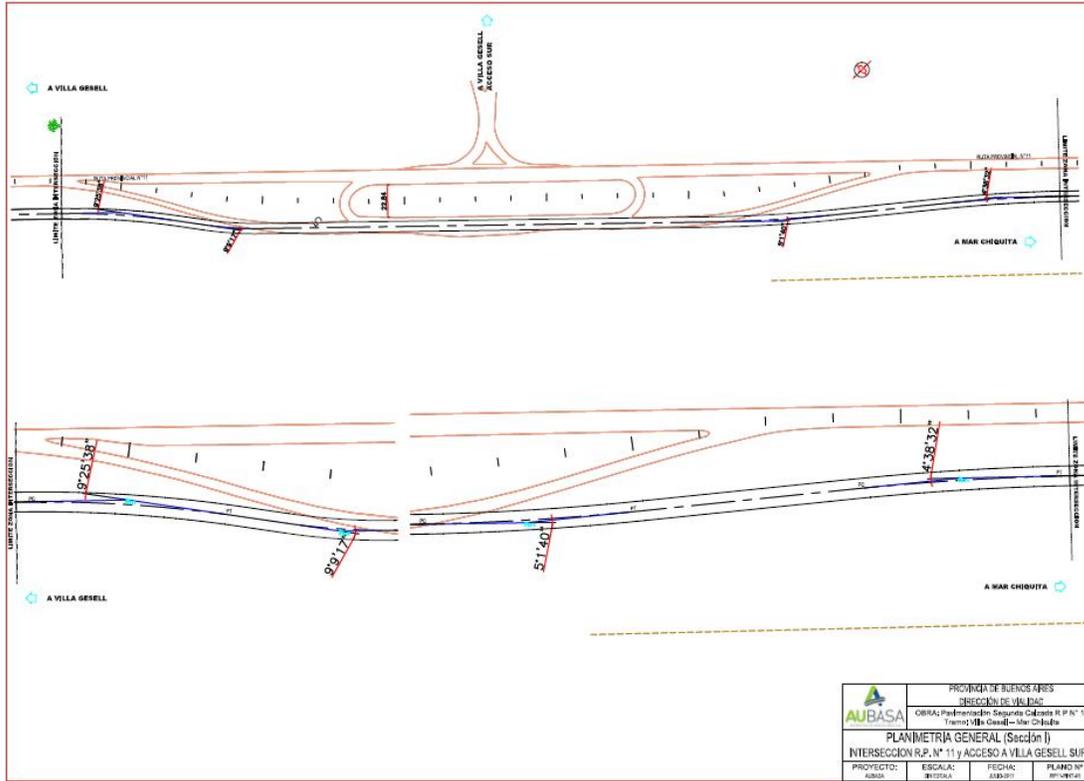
Planimetría Intersección RP N°11 y Acceso a Villa Gesell Sur
